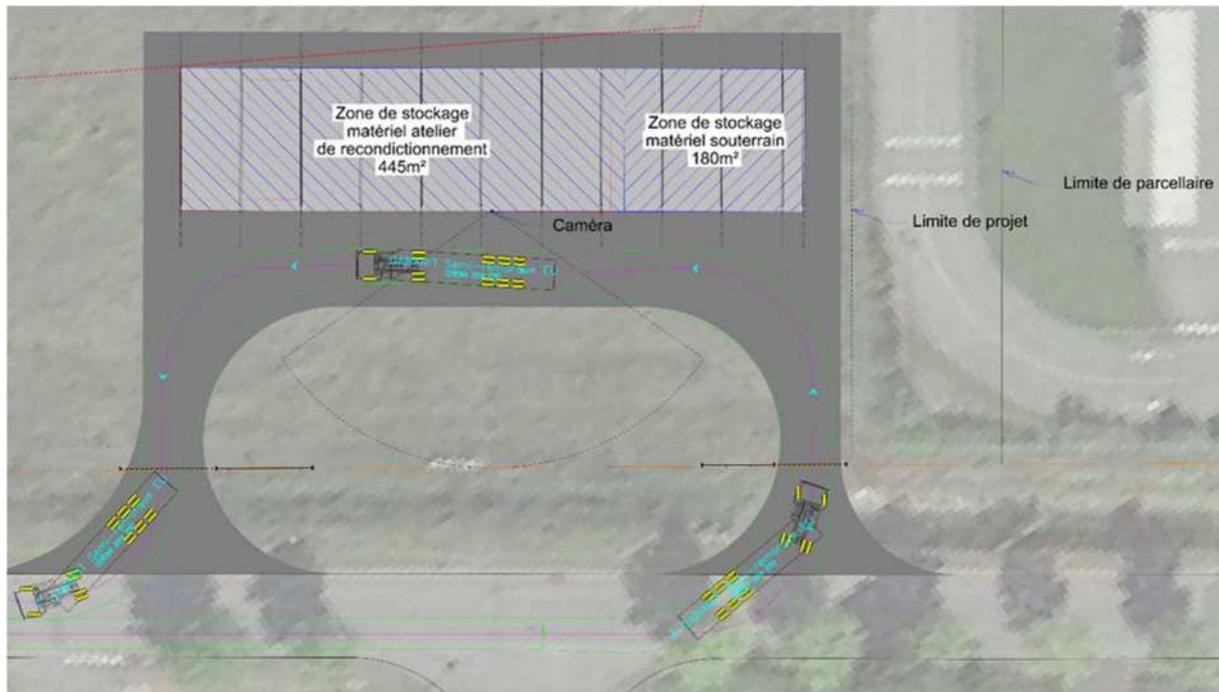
Extrait du plan 2D de la zone extérieure de stockage implantée sur la parcelle cadastrale n°419
